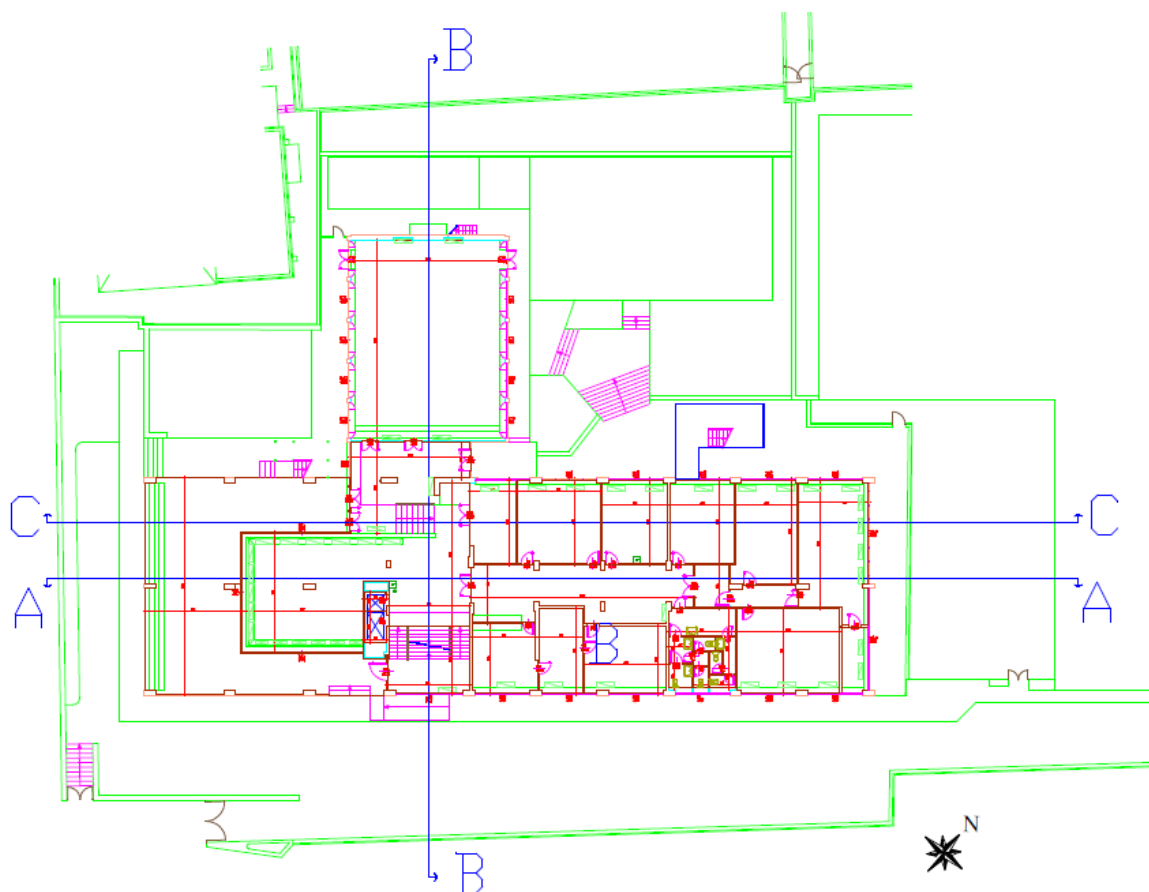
Pianta del piano terra e indicazione delle sezioni principali.
